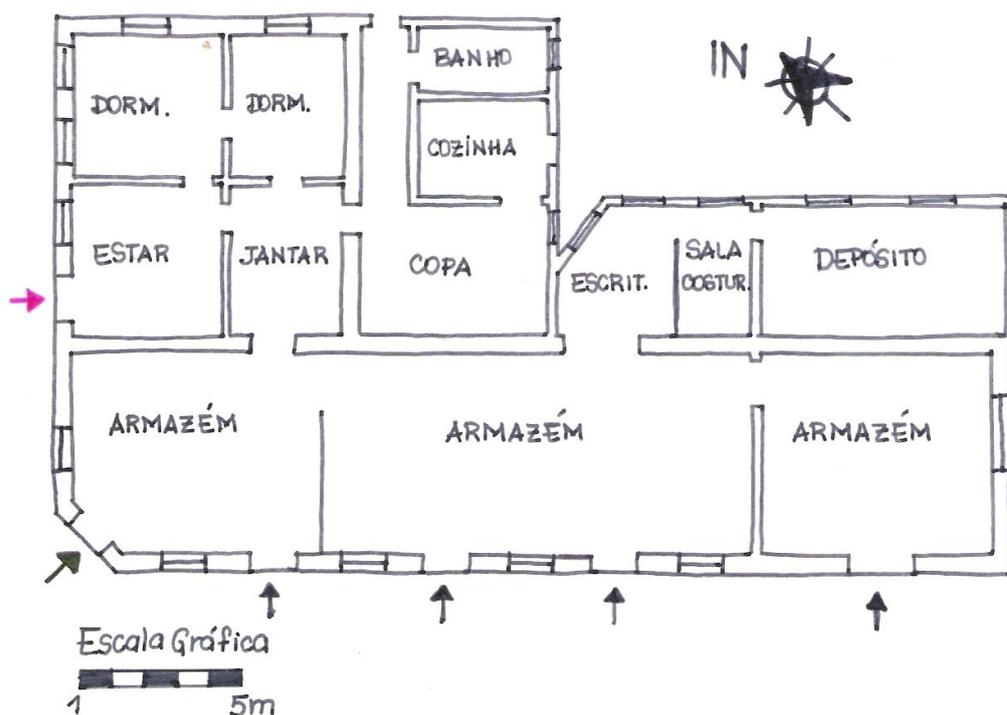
Planta baixa esquemática da edificação atualmente – 2011.
